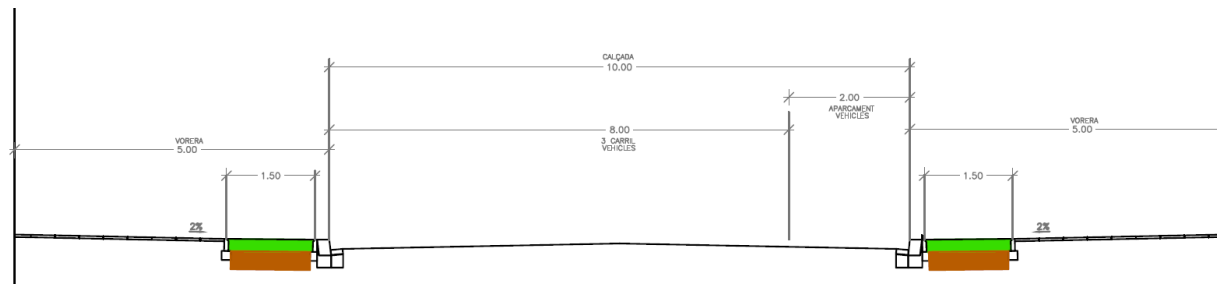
Sección transversal de la propuesta para la C/ Lepanto, caso a) (Tipo 2).
